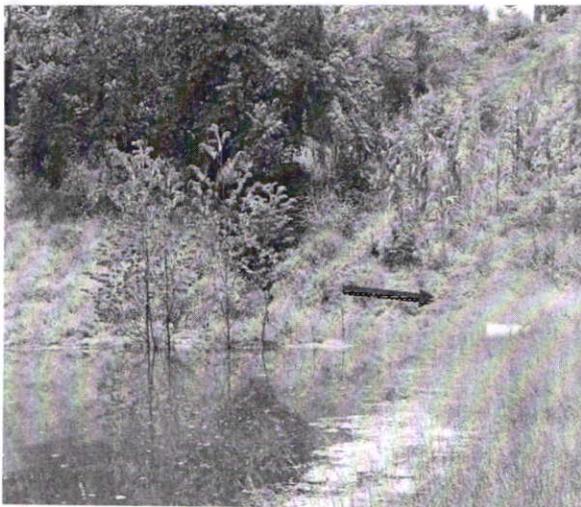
Tubería PVC para desague de aproximadamente 4 metros.
